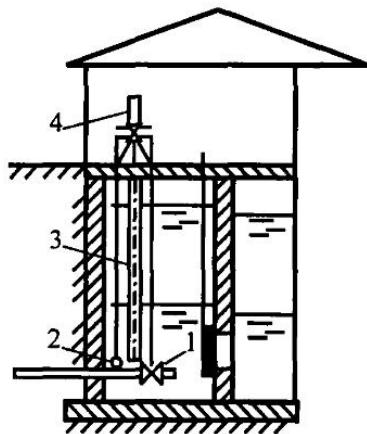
Схема установки оборудования для промывки самотечных линий: 1 – герметически закрывающийся затвор; 2 – быстрооткрывающийся вентиль; 3 – напорная колонна; 4 – патрубок для подключения вакуум-насоса
